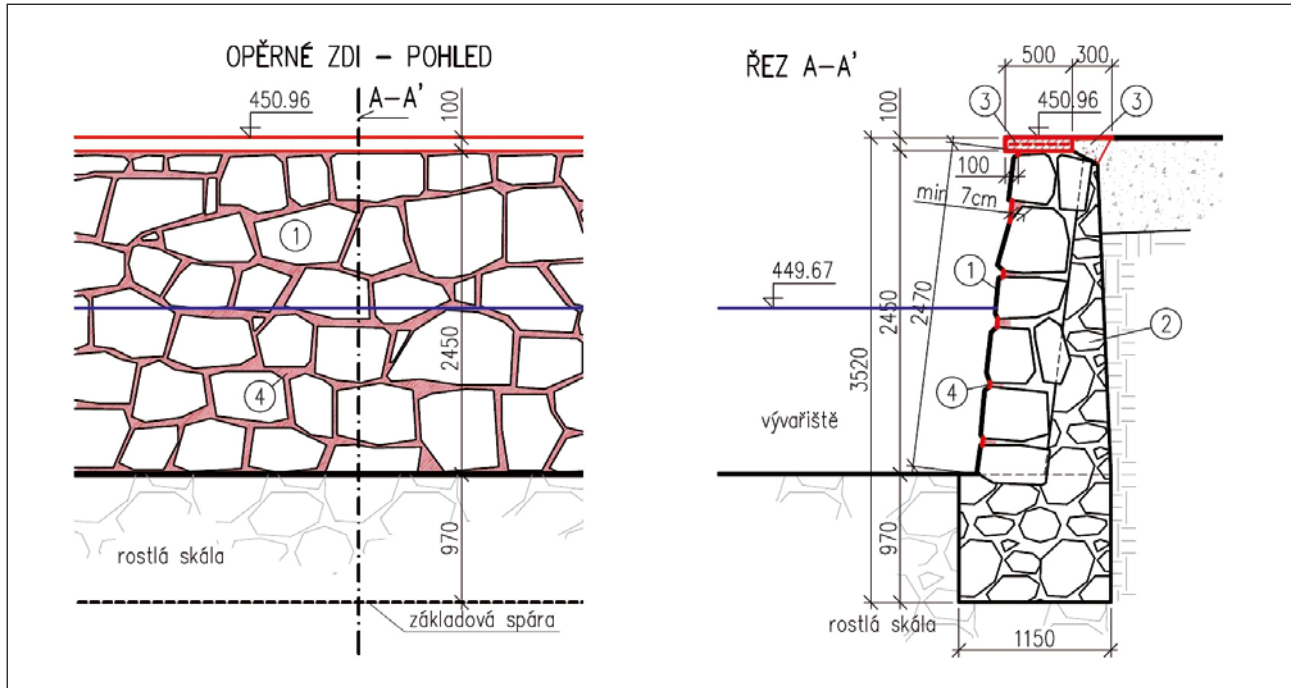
Pohled na vzor kamenné zdi zděné z lomového kamene na betonový základ, ve dně intravilánové úpravy bystřiny je provedena dlažba. Koruna zdi je chráněna železobetonovou římsou.
